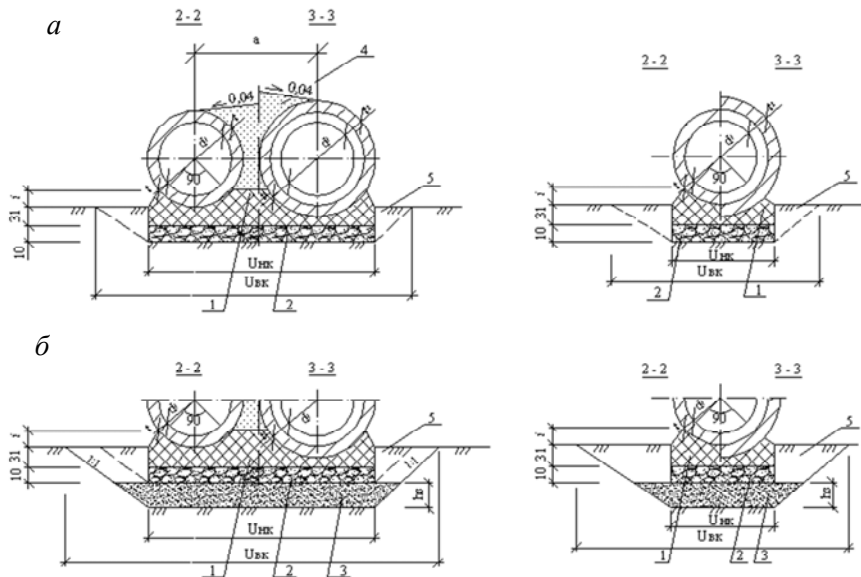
Поперечные разрезы 2–2 и 3–3 (см. рис. 2.9, а) фундаментной трубы: а – без замены грунта основания; б – с заменой: 1 – бетон фундамента В25; 2 – щебень толщиной 10 см; 3 – замена грунта основания; 4 – заполнение пазух двухчковой трубы бетоном В7,5; 5 – обратная засыпка котлована
